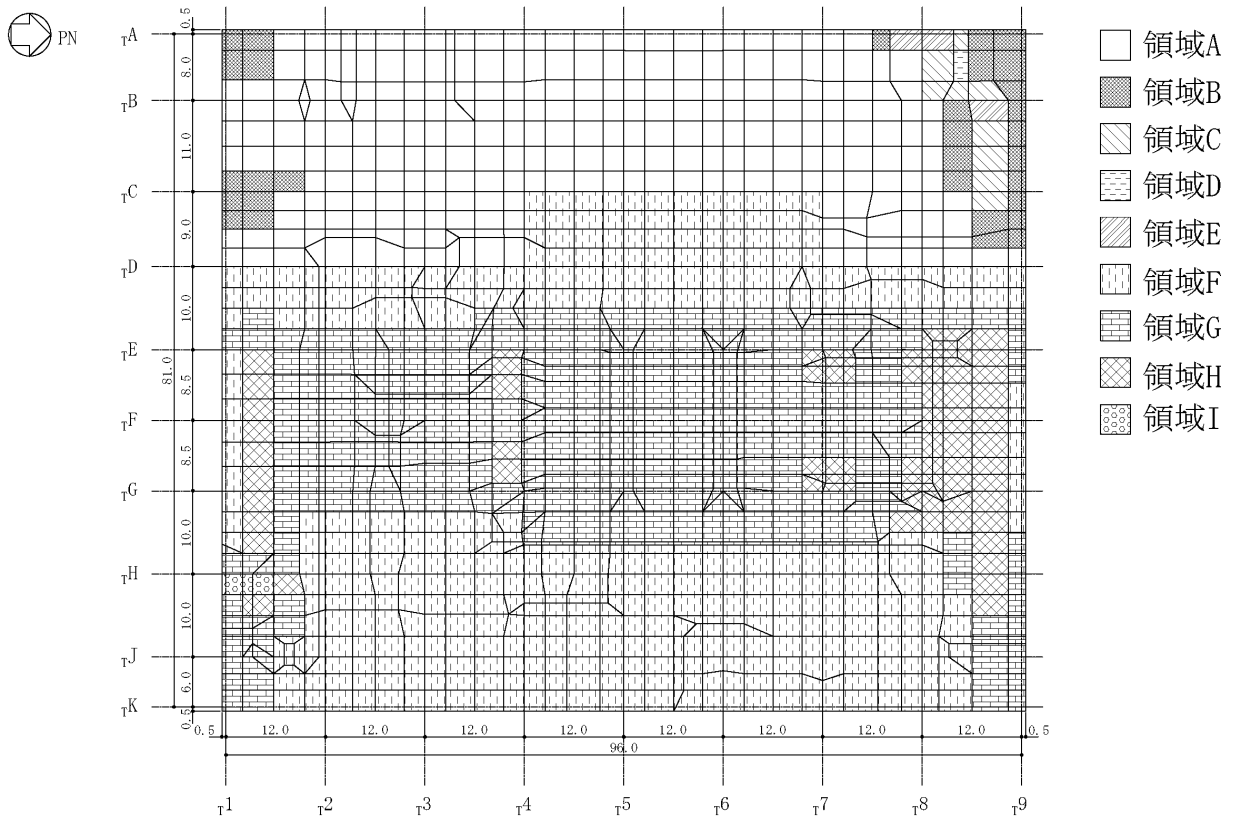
基礎スラブの配筋領域図 (NS 方向, 上ば筋) (単位 : m)
